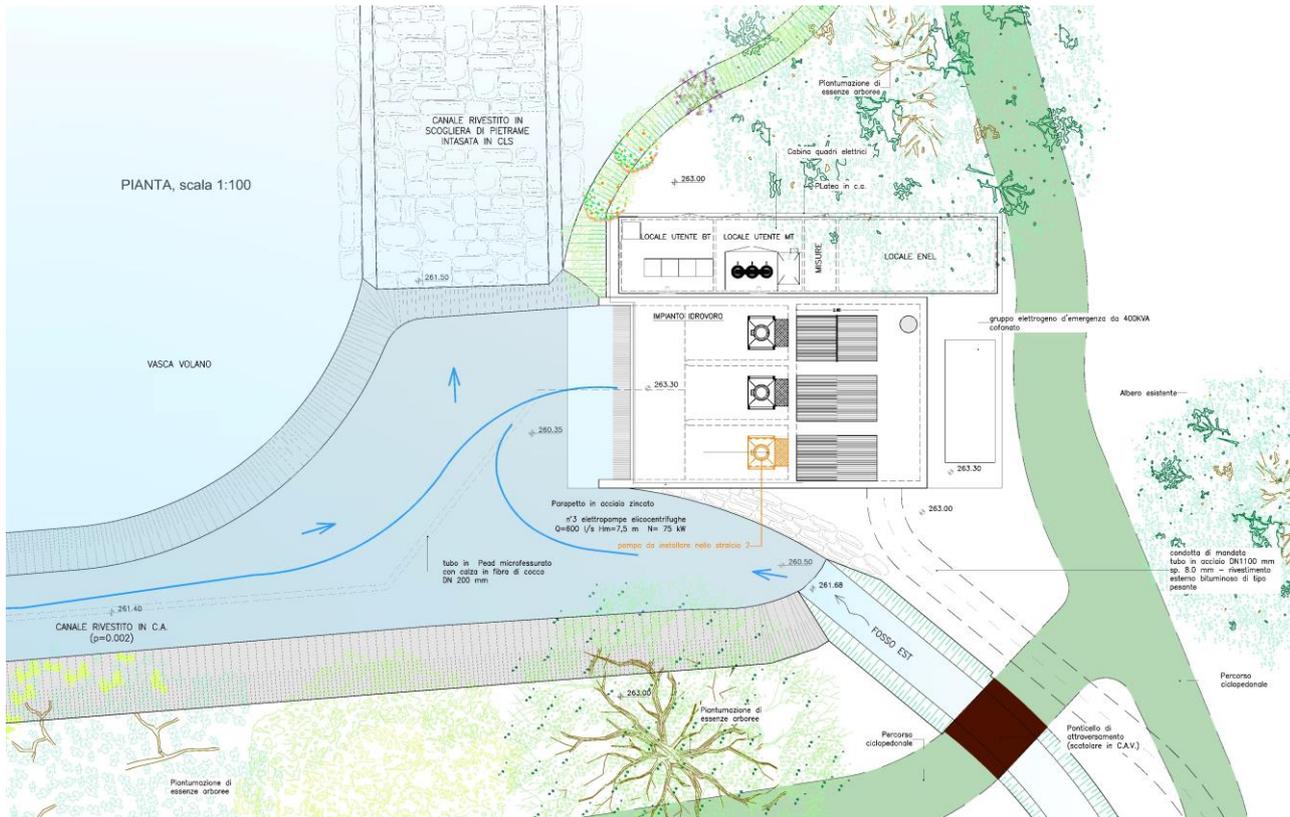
pianta dell'impianto idrovoro (estratto elaborato T-07).
